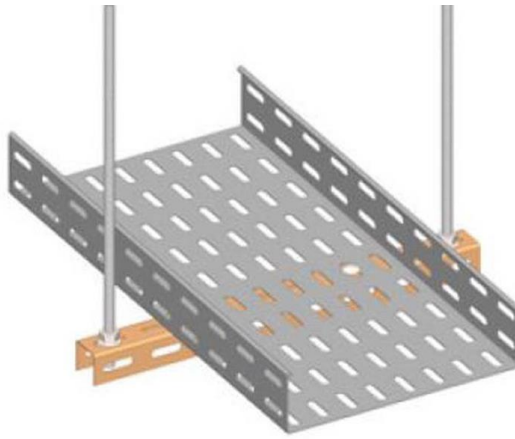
fixation au plafond de part et d'autre du chemin de câbles
